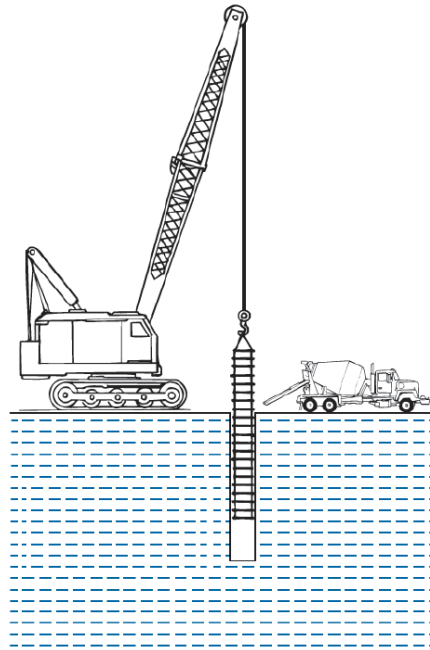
Colocado de columna con armadura de pila (Das, 2012).
